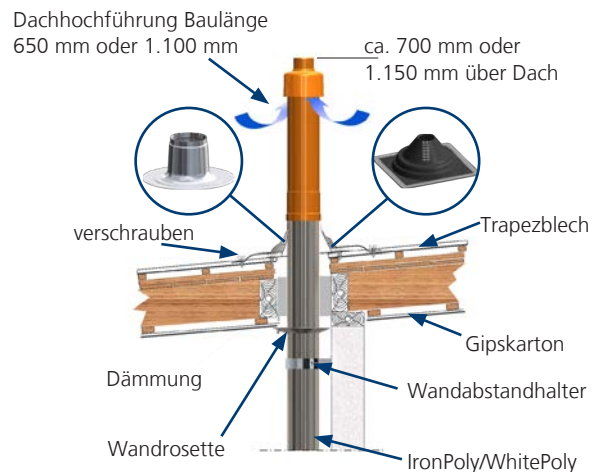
Beispiel Flachdachdurchführung für Trapezblechdeckung
